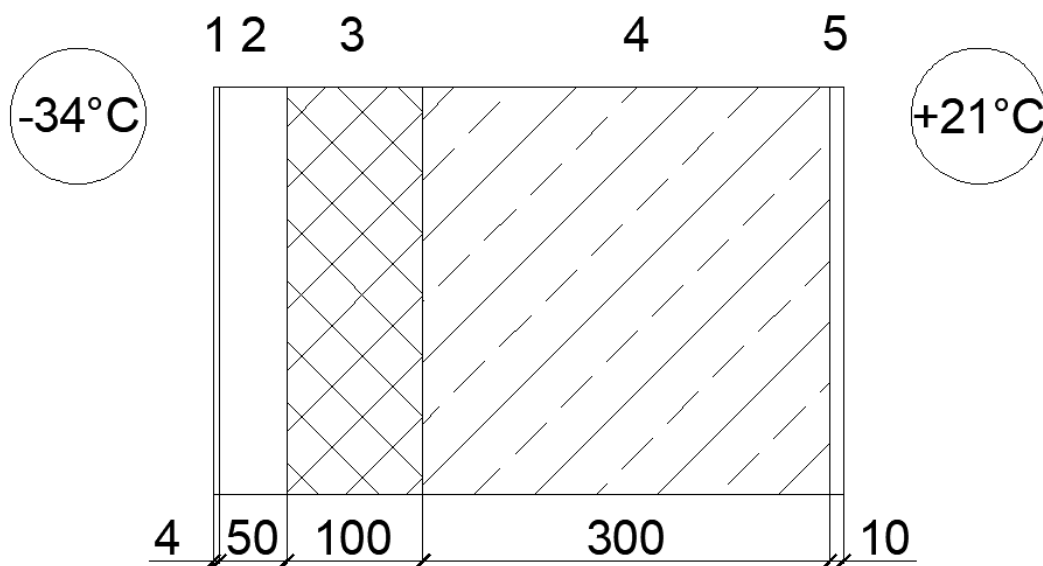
Разрез наружной стены из ячеистых блоков полистиролбетона.
